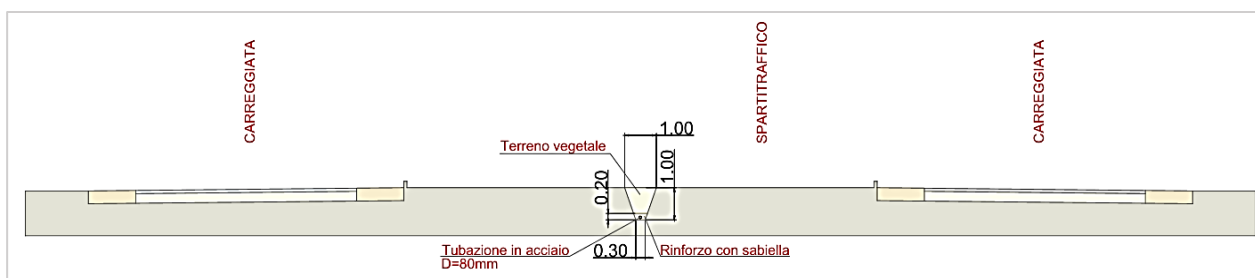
Tavola progetto PC.07 – Rete adduzione idrica. Particolare della sezione degli interventi
